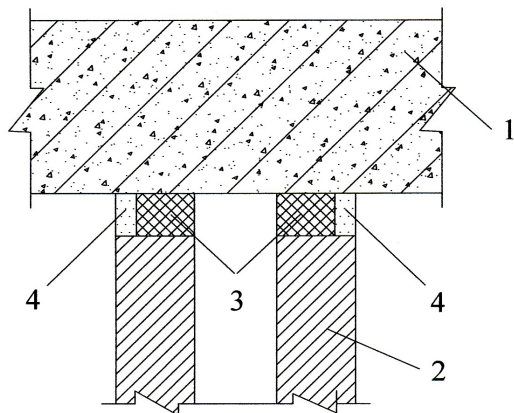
Схема конструктивного решения узла примыкания двойной перегородки к перекрытию.
